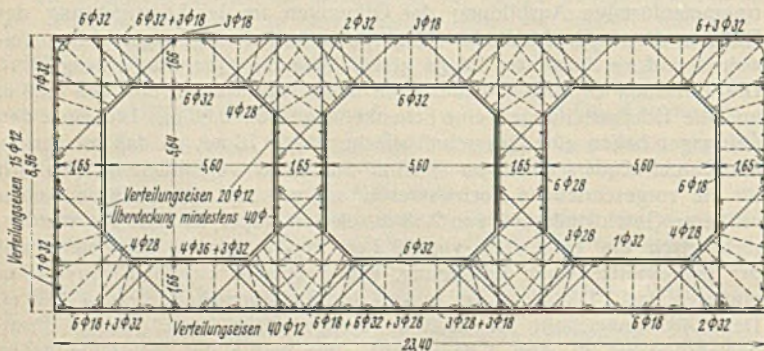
Eisenbewehrung des Dükerquerschnitts unter dem Leinpfad.
